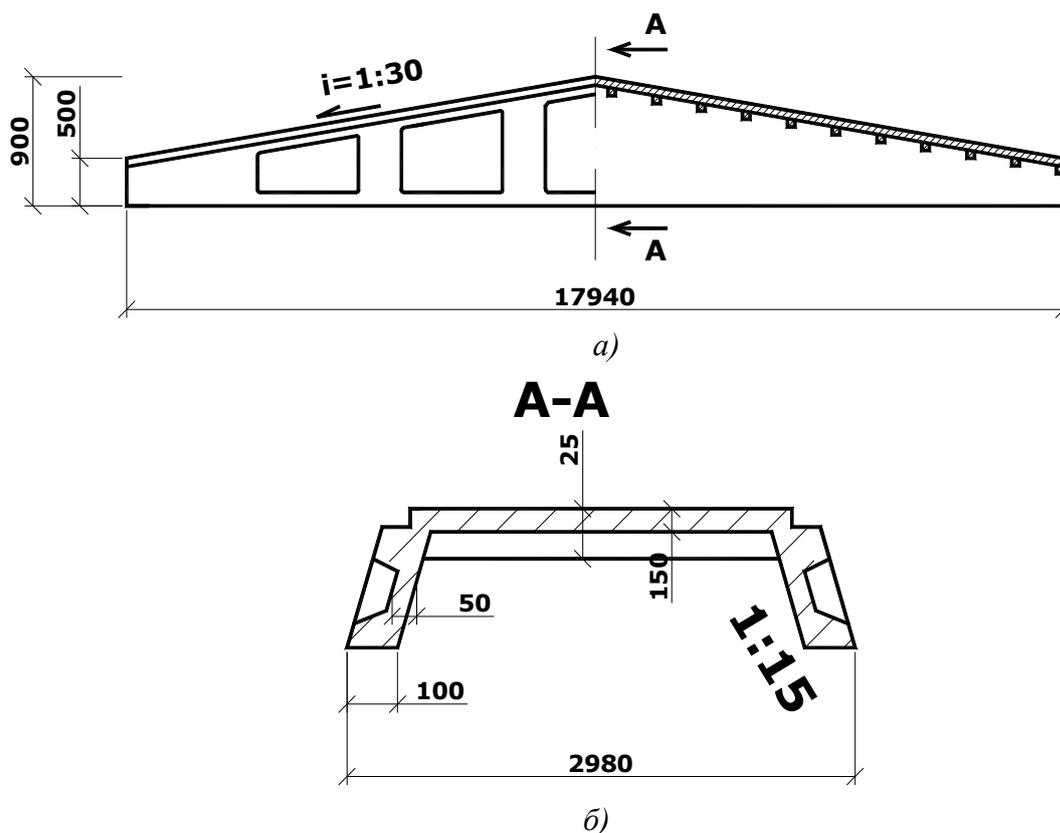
Плита ребристая под малоуклонную кровлю:
